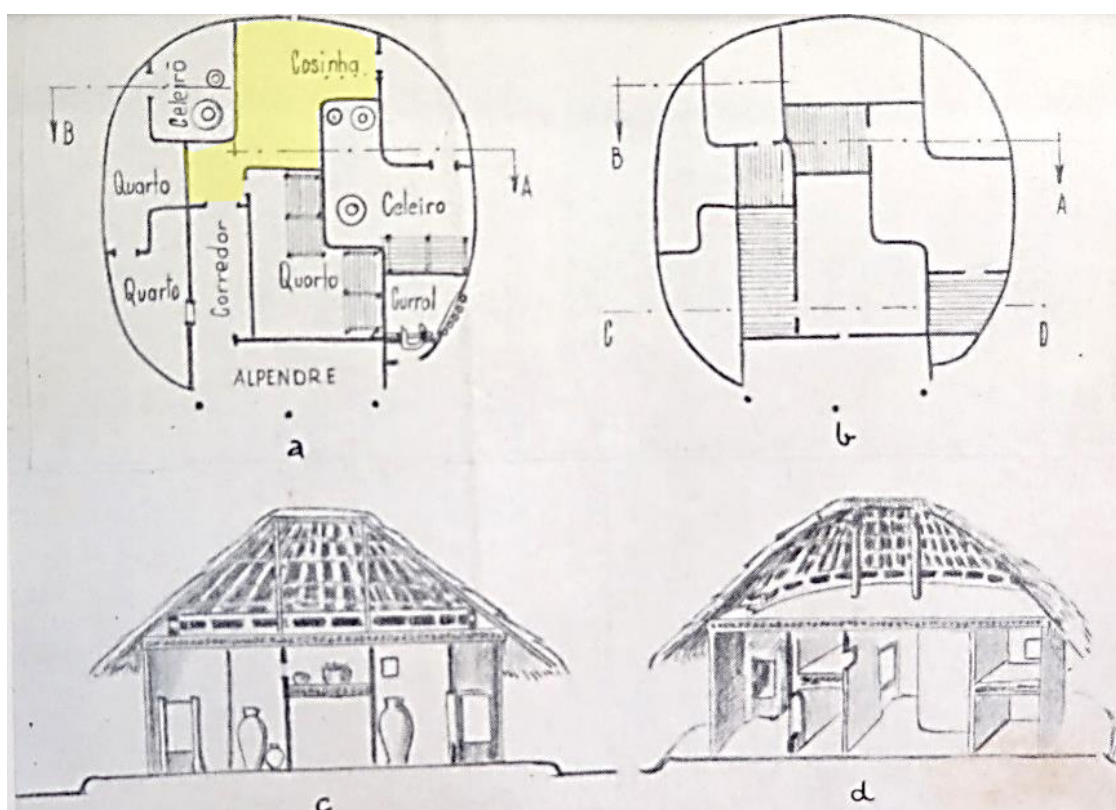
Casa balanta circular. Planta a 0,50m (a) com cozinha em destaque (da autora); planta a 2,50m (b), com os celeiros superiores; corte AB (c) e corte em perspectiva CD (d).
